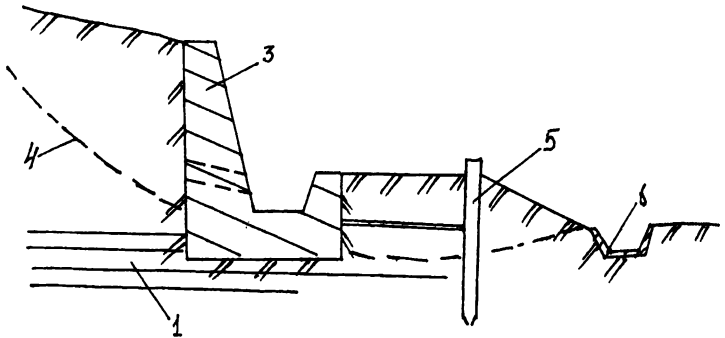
Схема крепления склона подпорной стенкой в сочетании со шпунтовым рядом:
